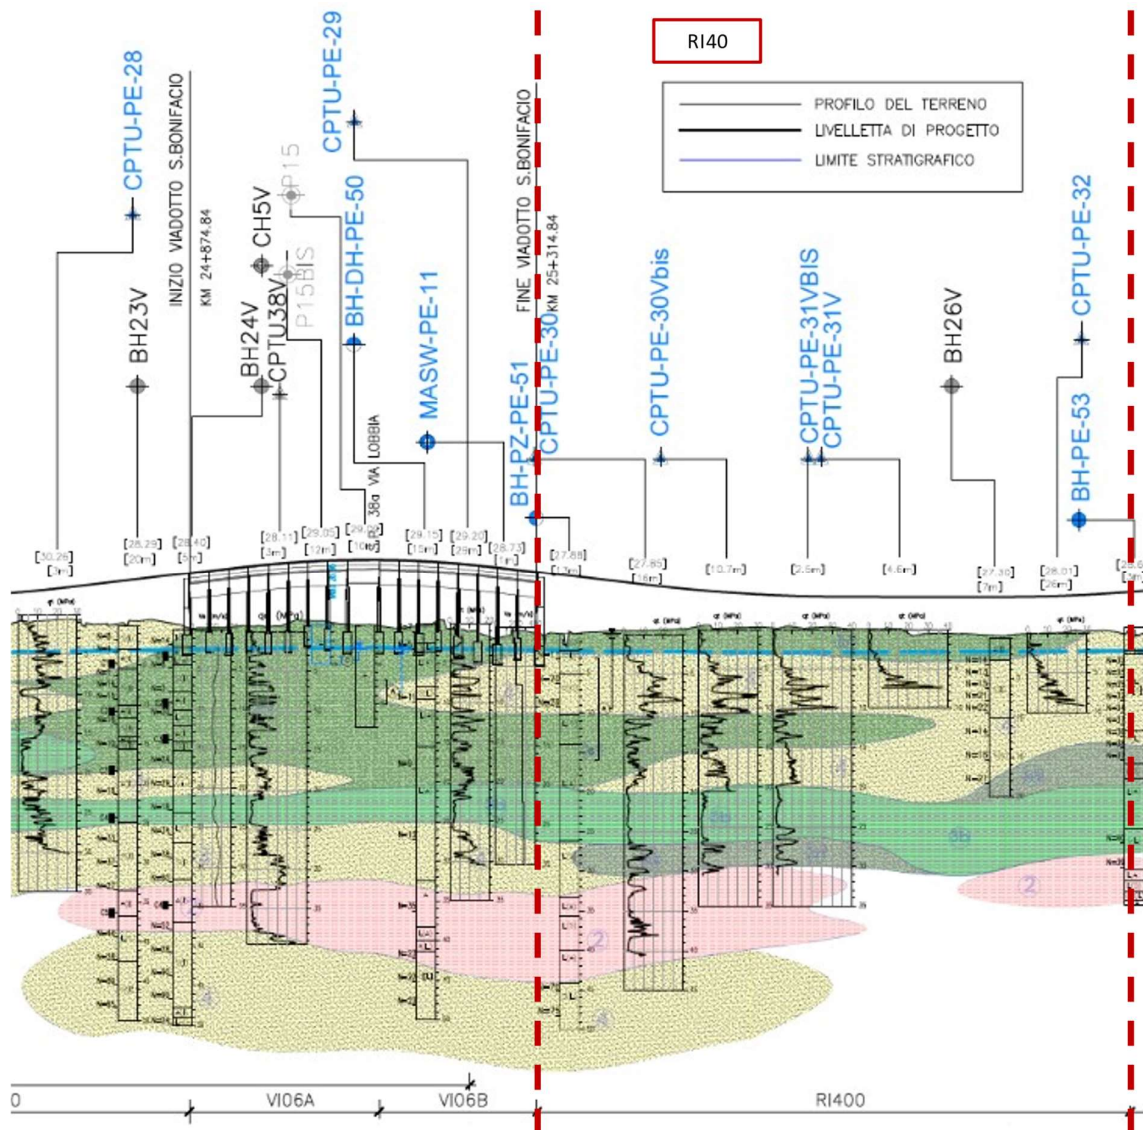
Profilo Geotecnico Rilevato RI40, estratto dal Profilo Geotecnico Generale (Doc. Rif. [3])
